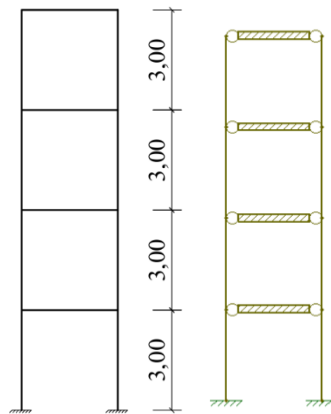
Modelo Shear Building (a) e modelo de Pórtico Plano de Referência (b)
